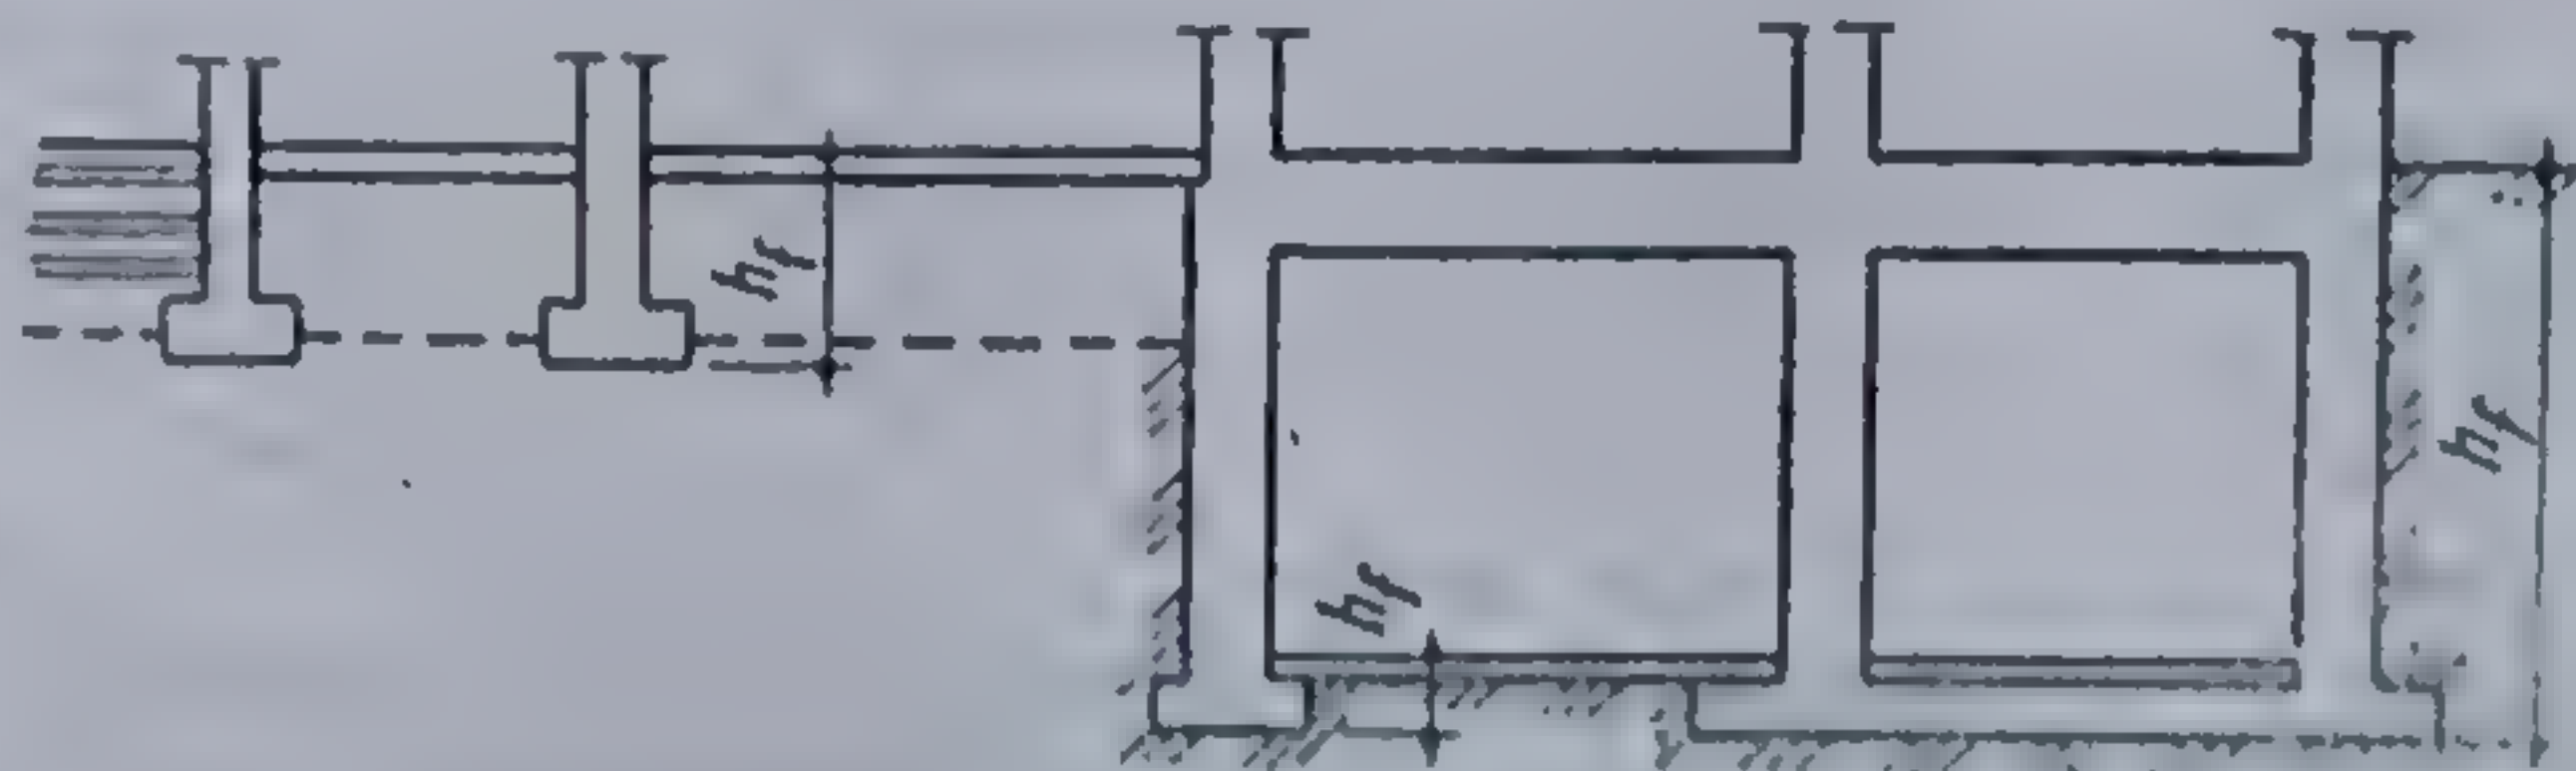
Adîncimea de fundare la construcții de clădiri.
